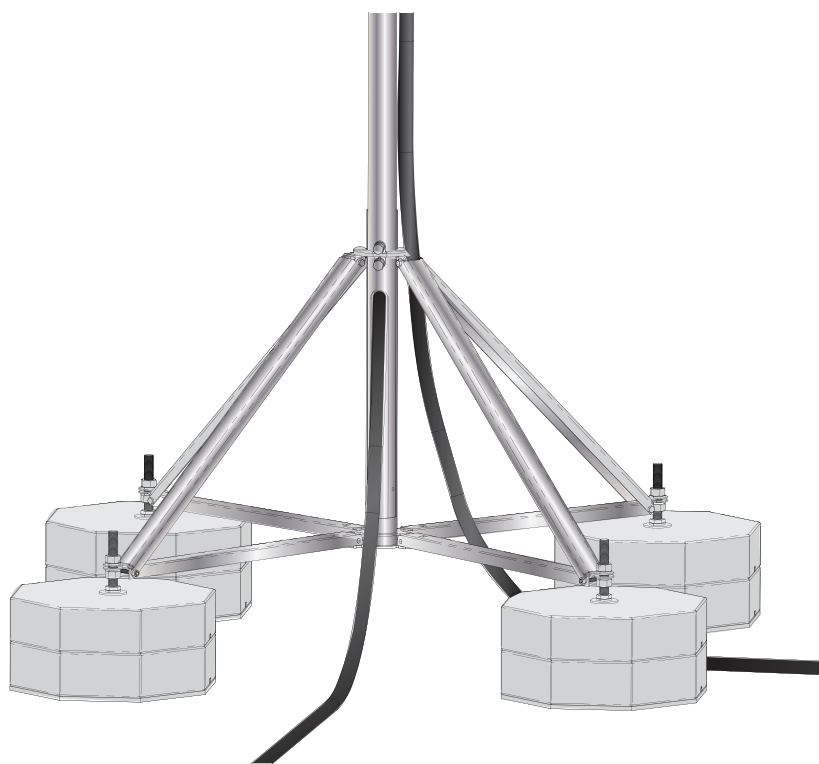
Disposizione dei blocchi di calcestruzzo su una posizione orizzontale
